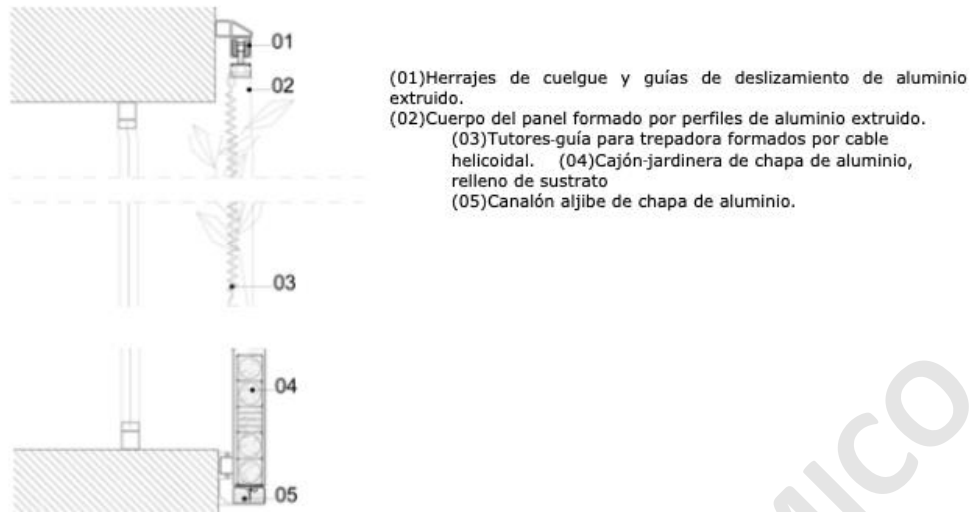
Detalle constructivo 1 fachadas deslizantes
